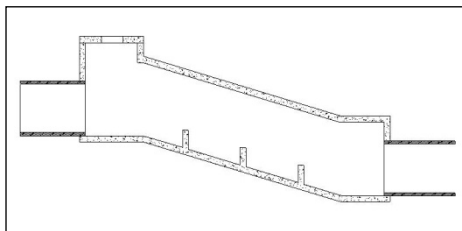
Esquema de cámara de quiebre con tabiques verticales
